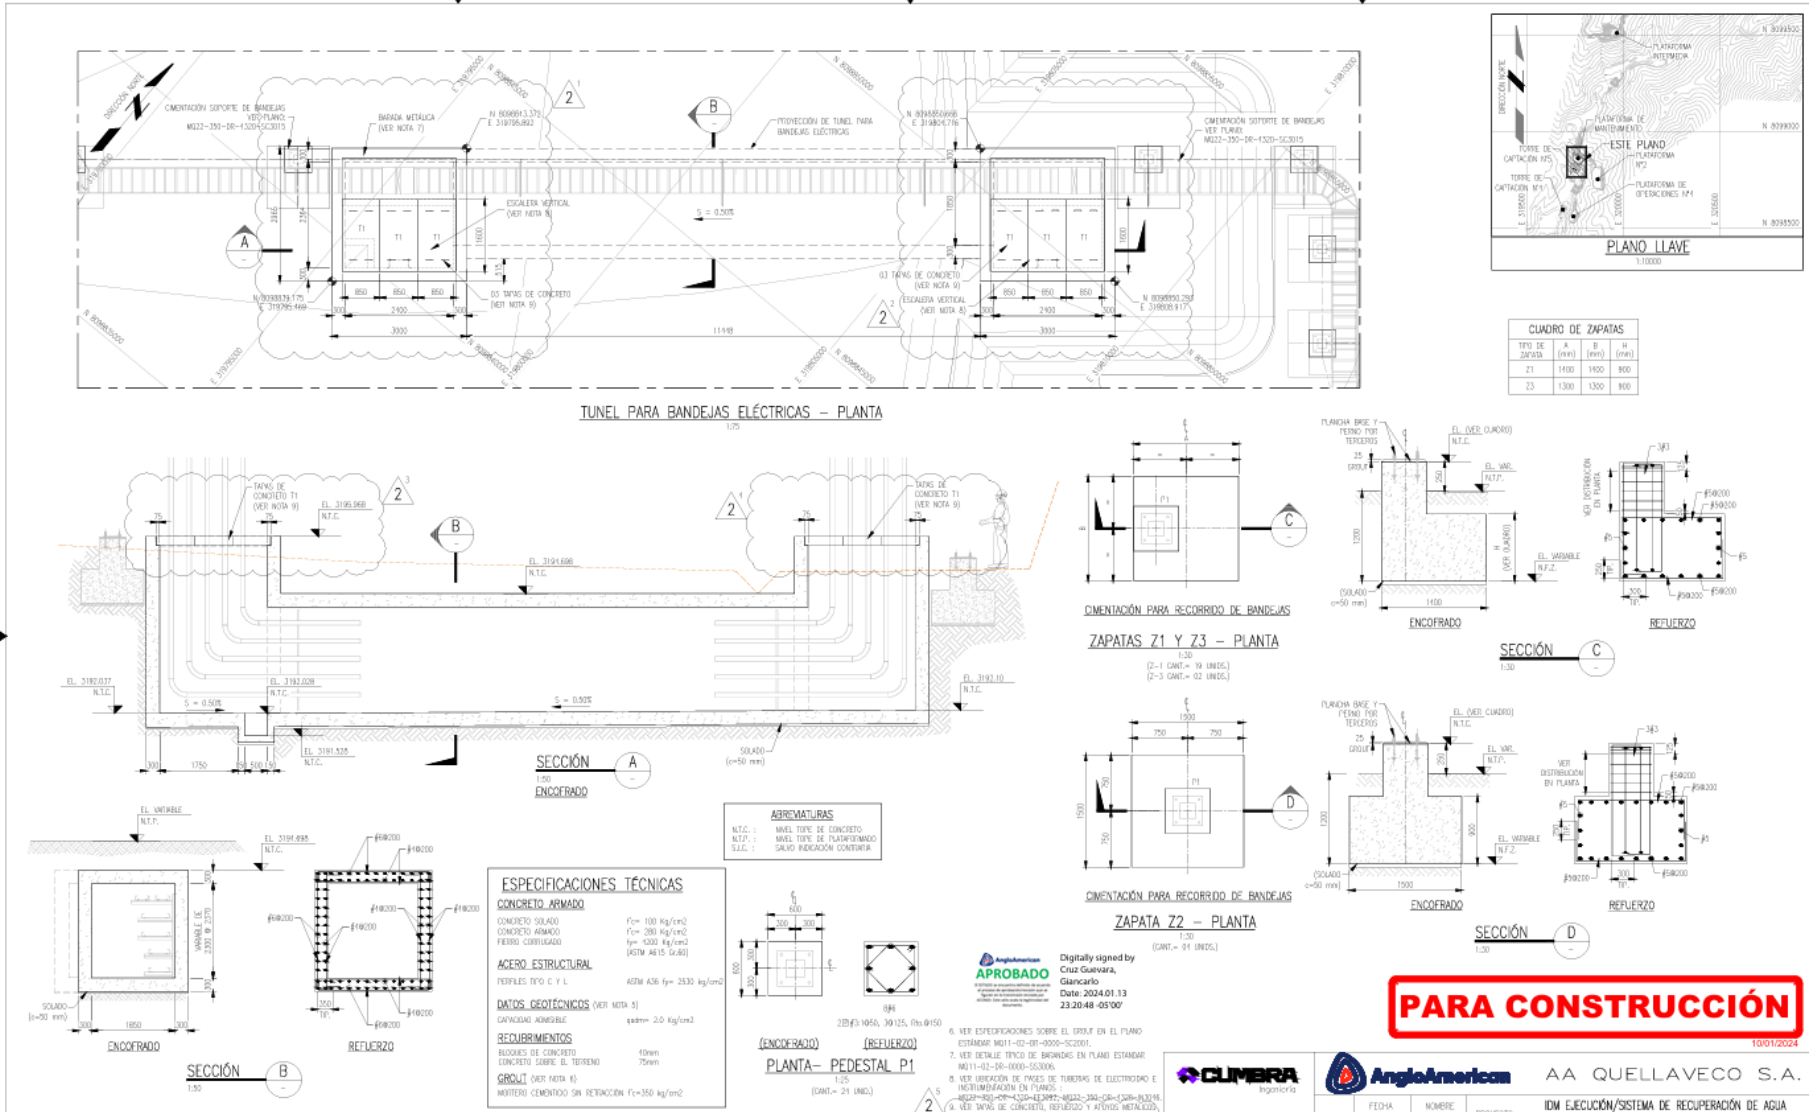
PLANO DE SOPORTE DE BANDEJAS CANALETAS ELECTRICAS – CIMENTACION, TC.05 (Área: Oficina Técnica)
